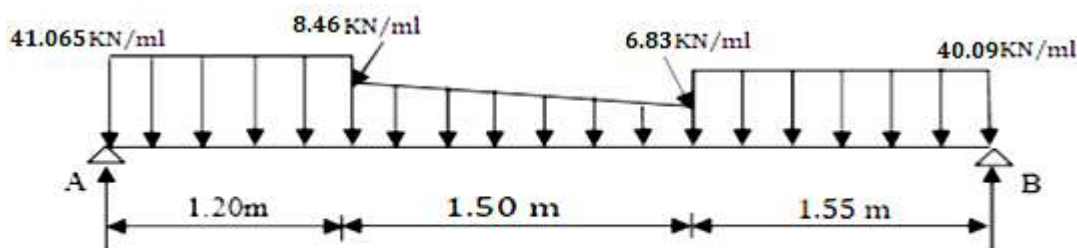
Schéma statique de la poutre brisée à l'ELS
